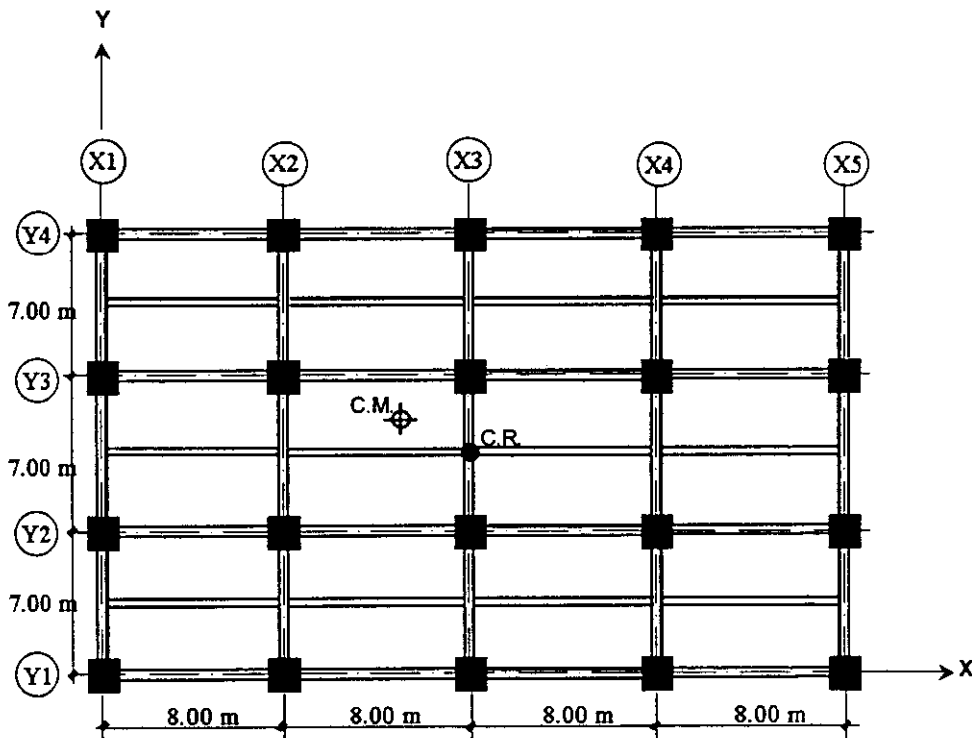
Planta del edificio de ocho niveles diseñado por Luaces (1995).
